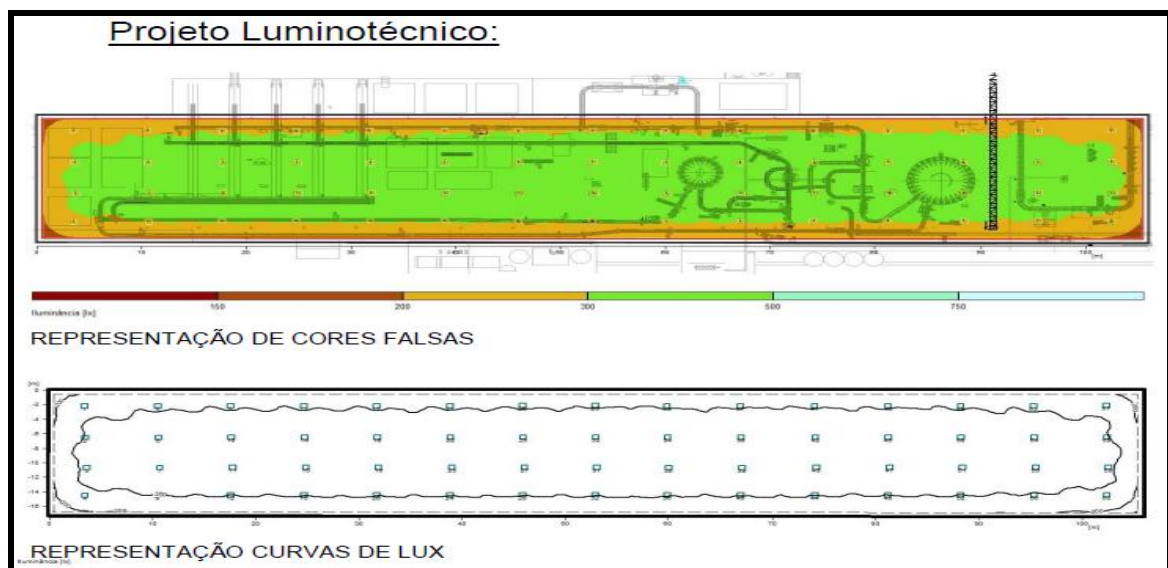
Planta do prédio da produção – Sinalização dos pontos de instalação.
